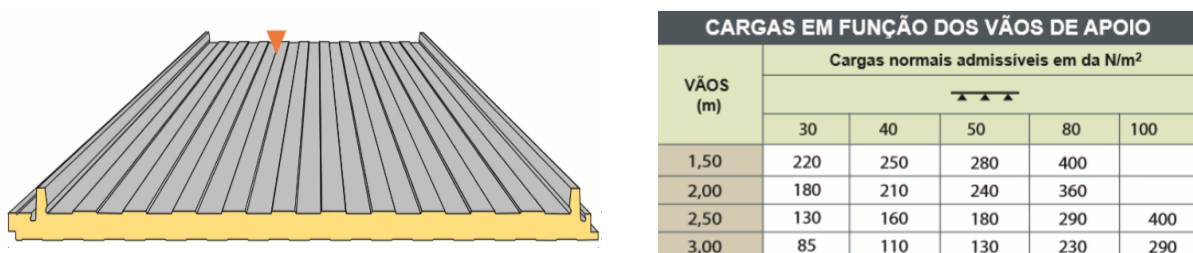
Elementos para verificação de segurança dos painéis sandwich de cobertura.
